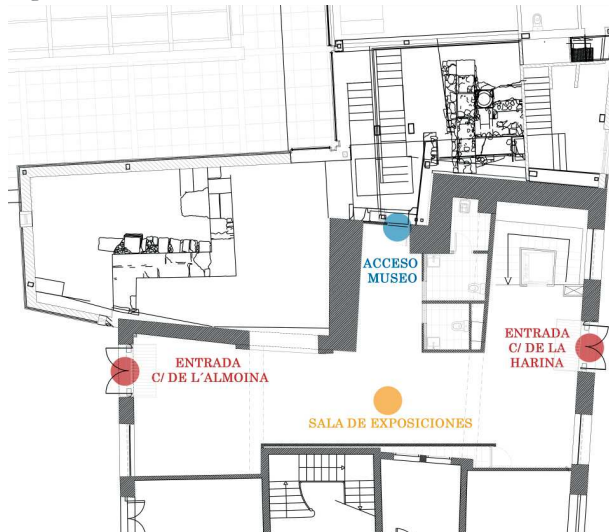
Plano planta baja del edificio de Punt de Gantxo.
